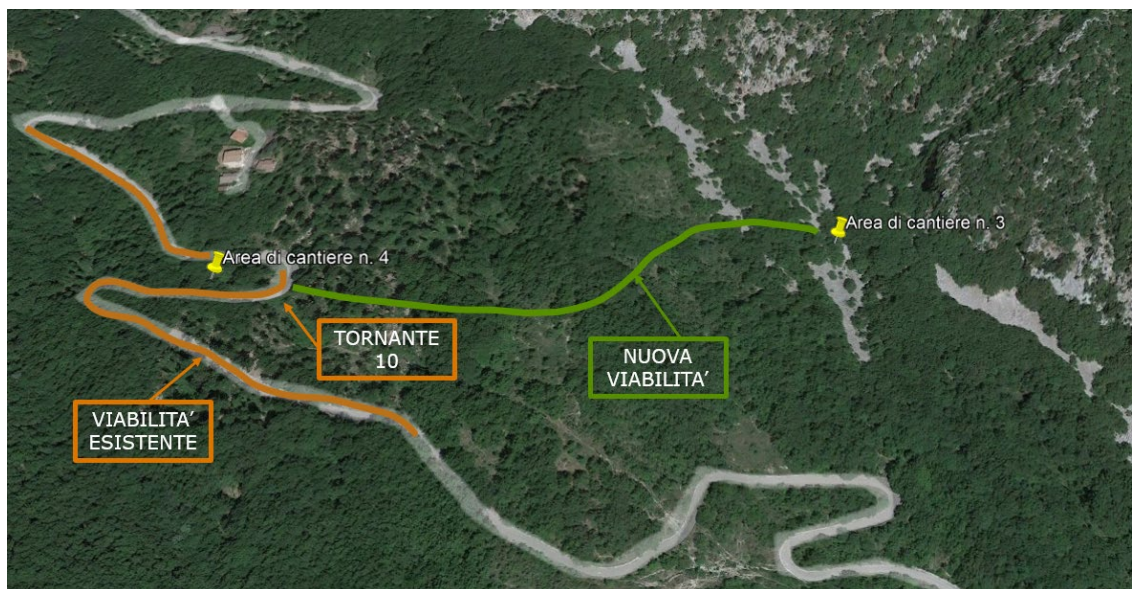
Viabilità di accesso alle aree di cantiere n. 3 e n. 4
